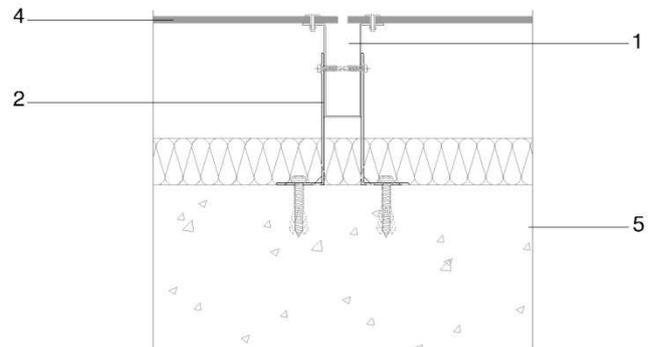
Sección horizontal con perfil  $\Omega$  (punto de carga).
